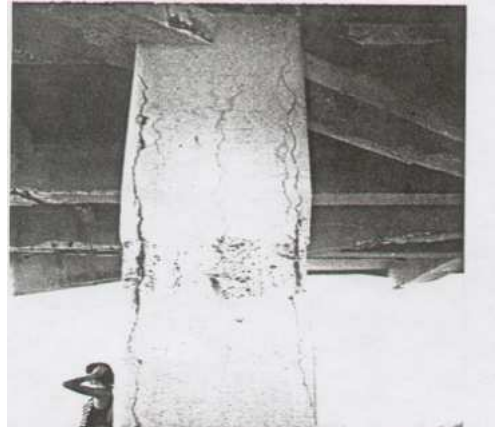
Fisurarea și desprinderea betonului în lungul armăturii de rezistență corodate a stâlpului. Zonă cu piatră de ciment degradată (zona de spargere a valurilor mării pe timp de furtună/anotimp friguros)
